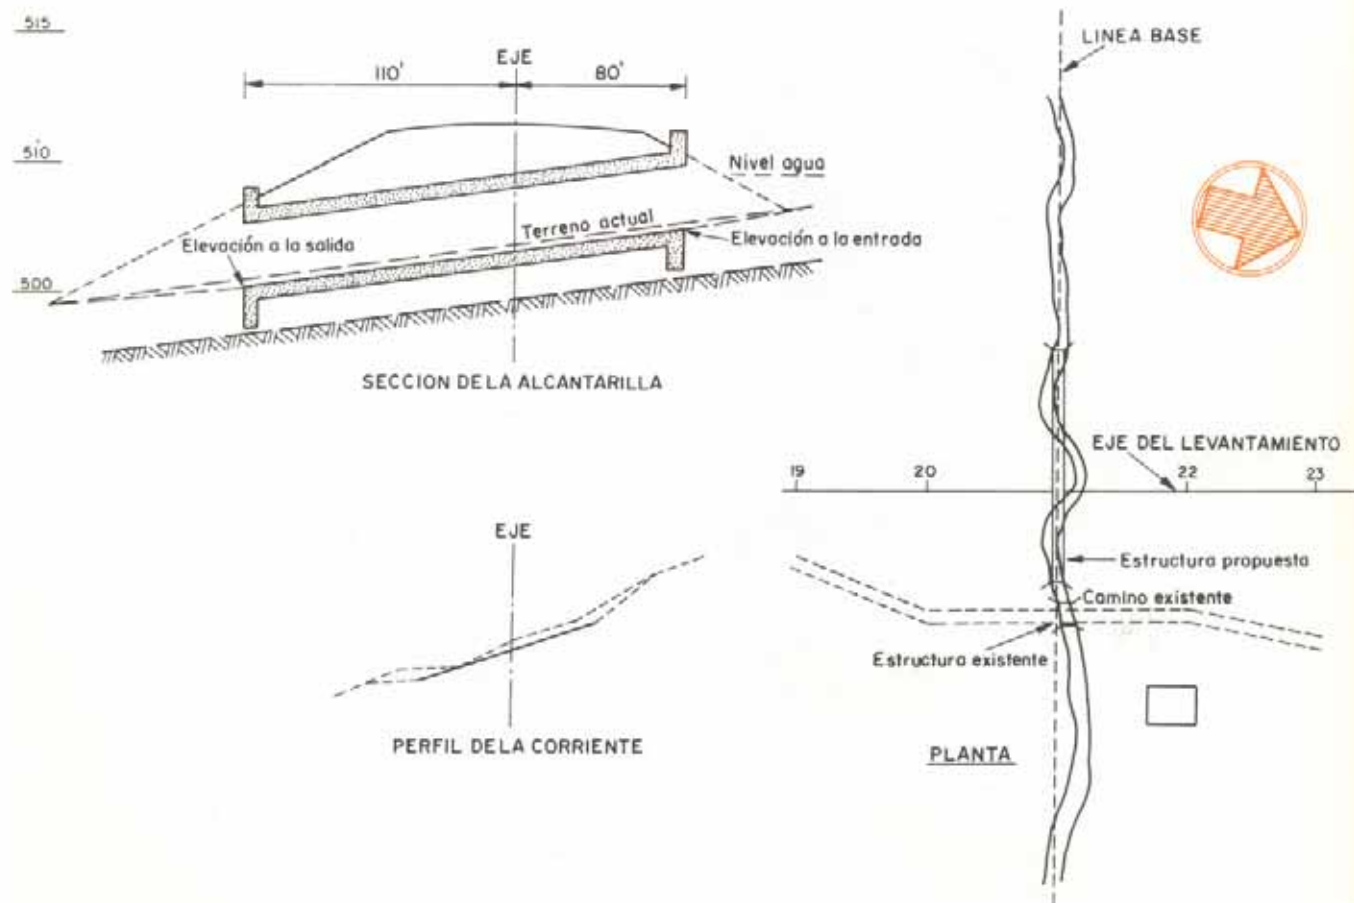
Levantamiento topográfico para el emplazamiento de una alcantarilla.
